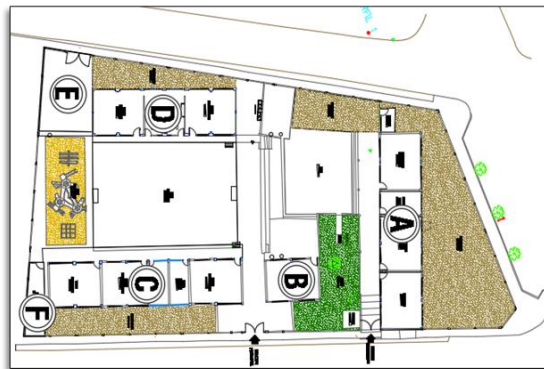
Planimetría existente de la I.E.I. N°300 Santa María de la Esperanza.
